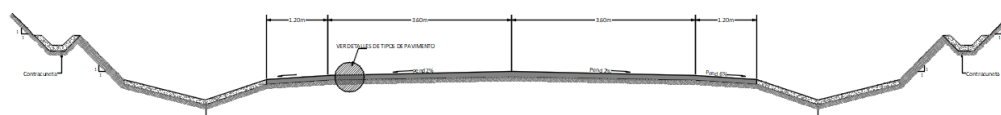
Sección Transversal de la carretera con corte a ambos lados.
